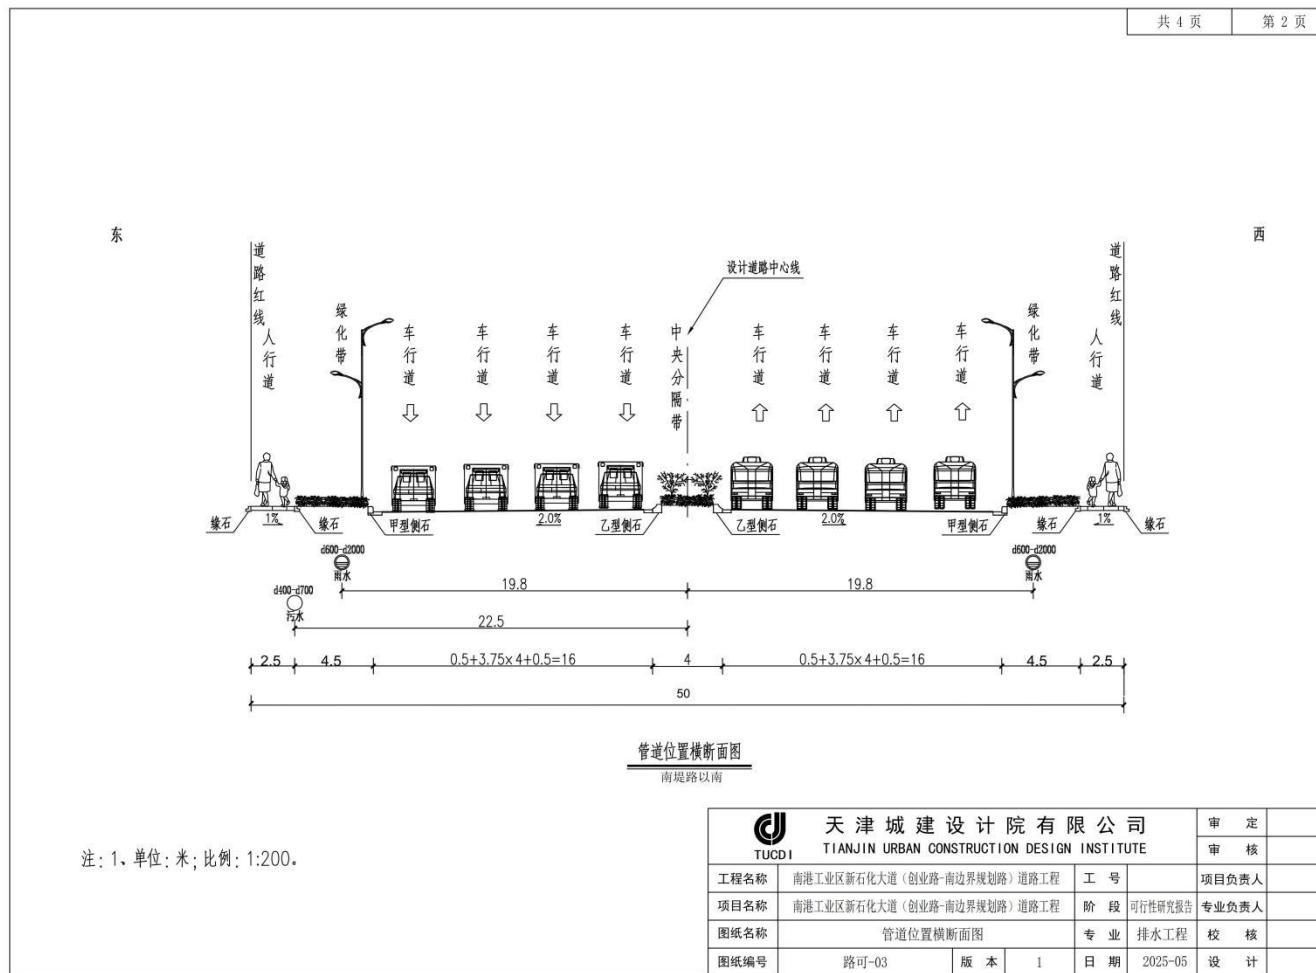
南堤路以南标准段雨水、污水排放管道工程断面图
